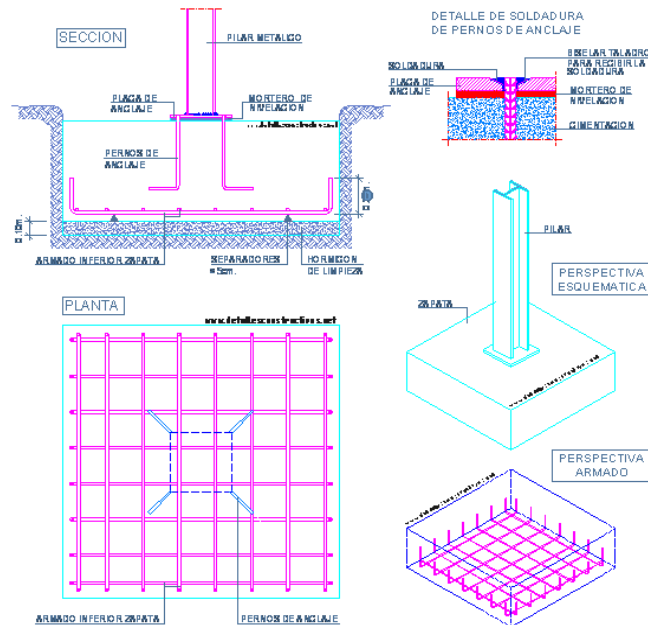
Detalle de zapata aislada. (Universidad la Laguna, 2013)
